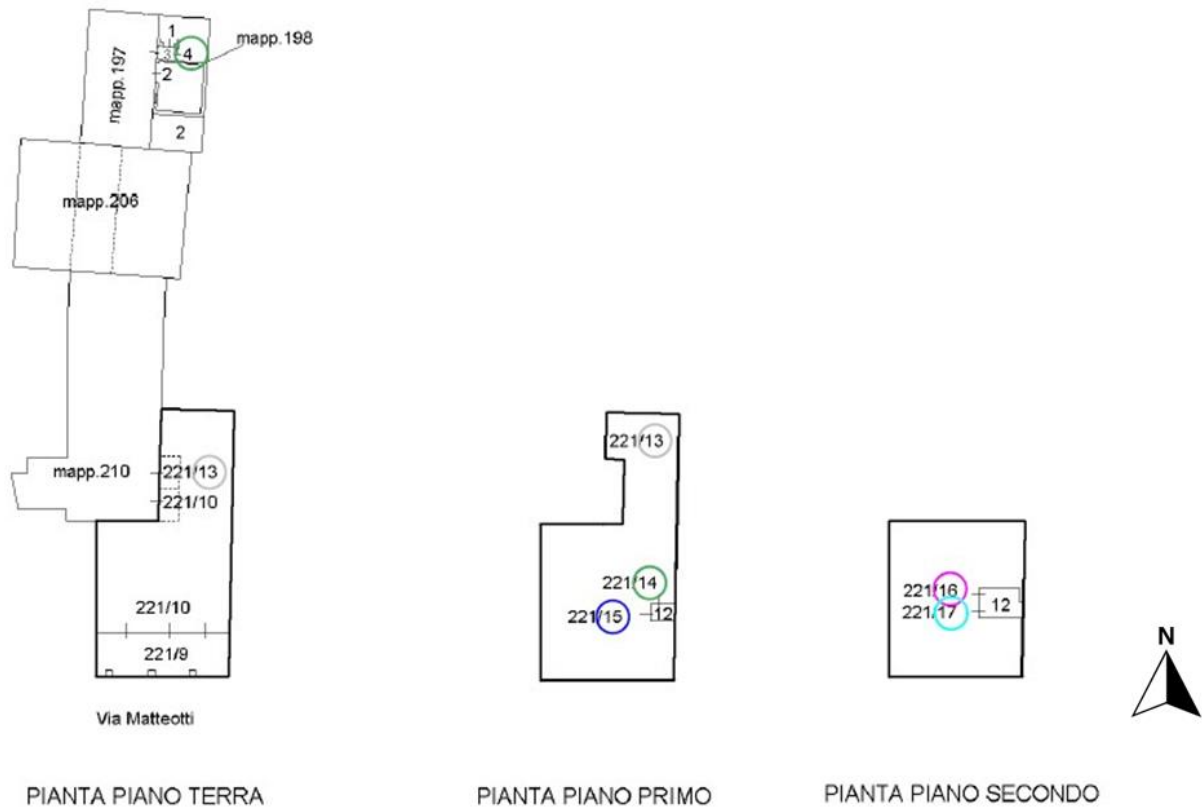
Elaborato planimetrico unione degli elaborati planimetrici particelle:198/221 in cui sono indicati dello stesso colore la suddivisione dei lotti oggetto di perizia, Fuori scala
